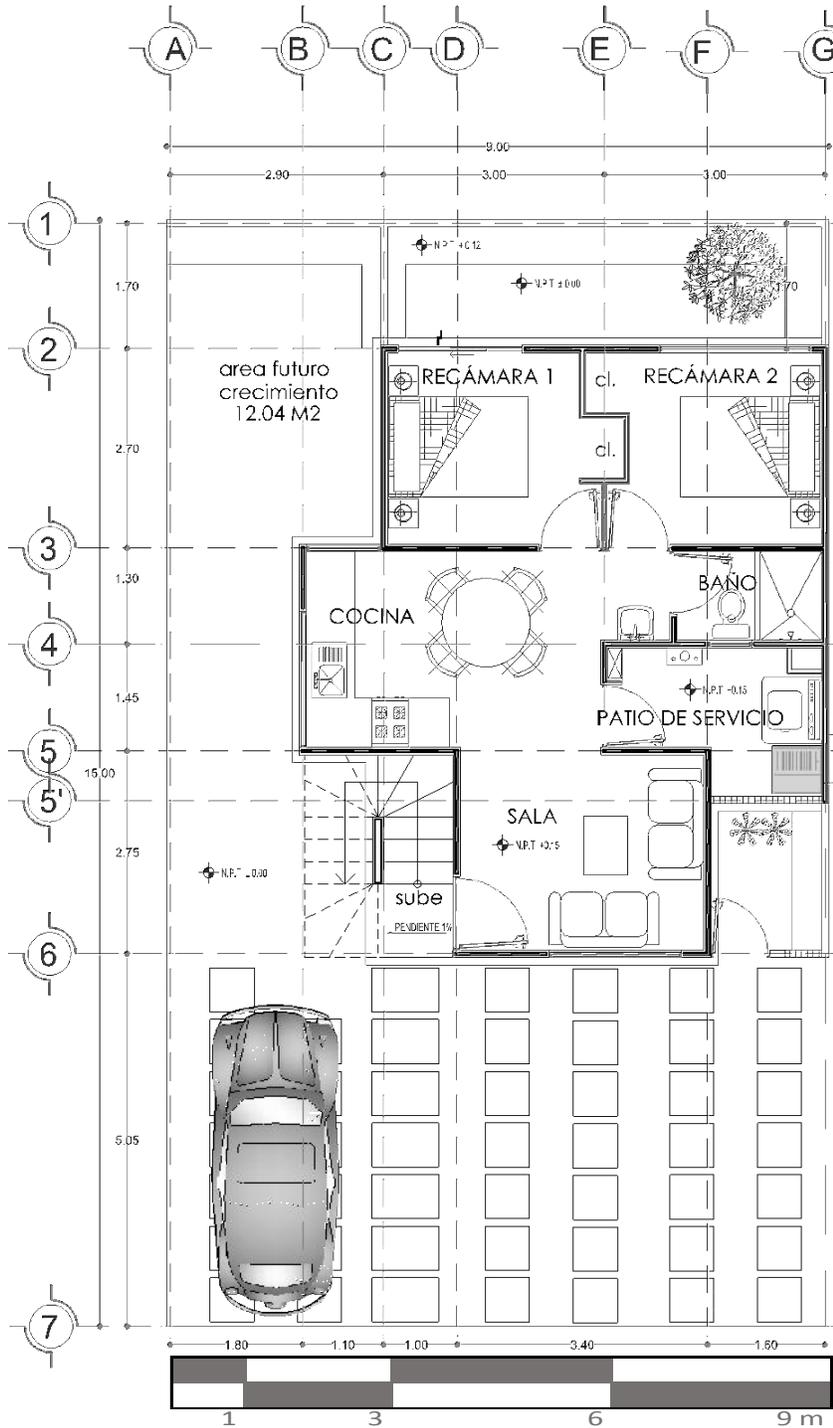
Planta Arquitectónica del Prototipo Triplex.
